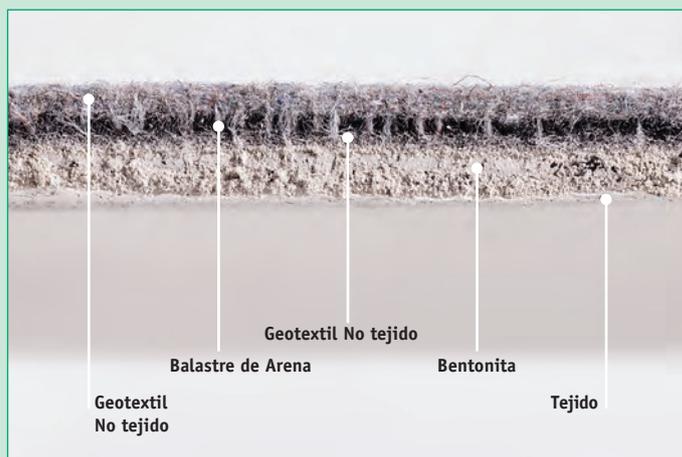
Sección transversal de Bentofix® BZ 13-B.
